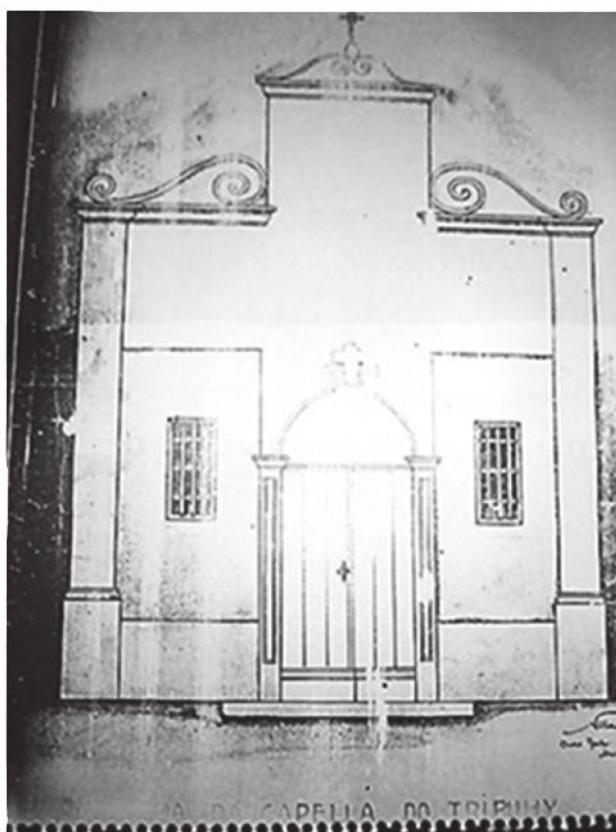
Fachada da Capela do Tripuy desenhada em formato Ao – Ouro Preto/MG
